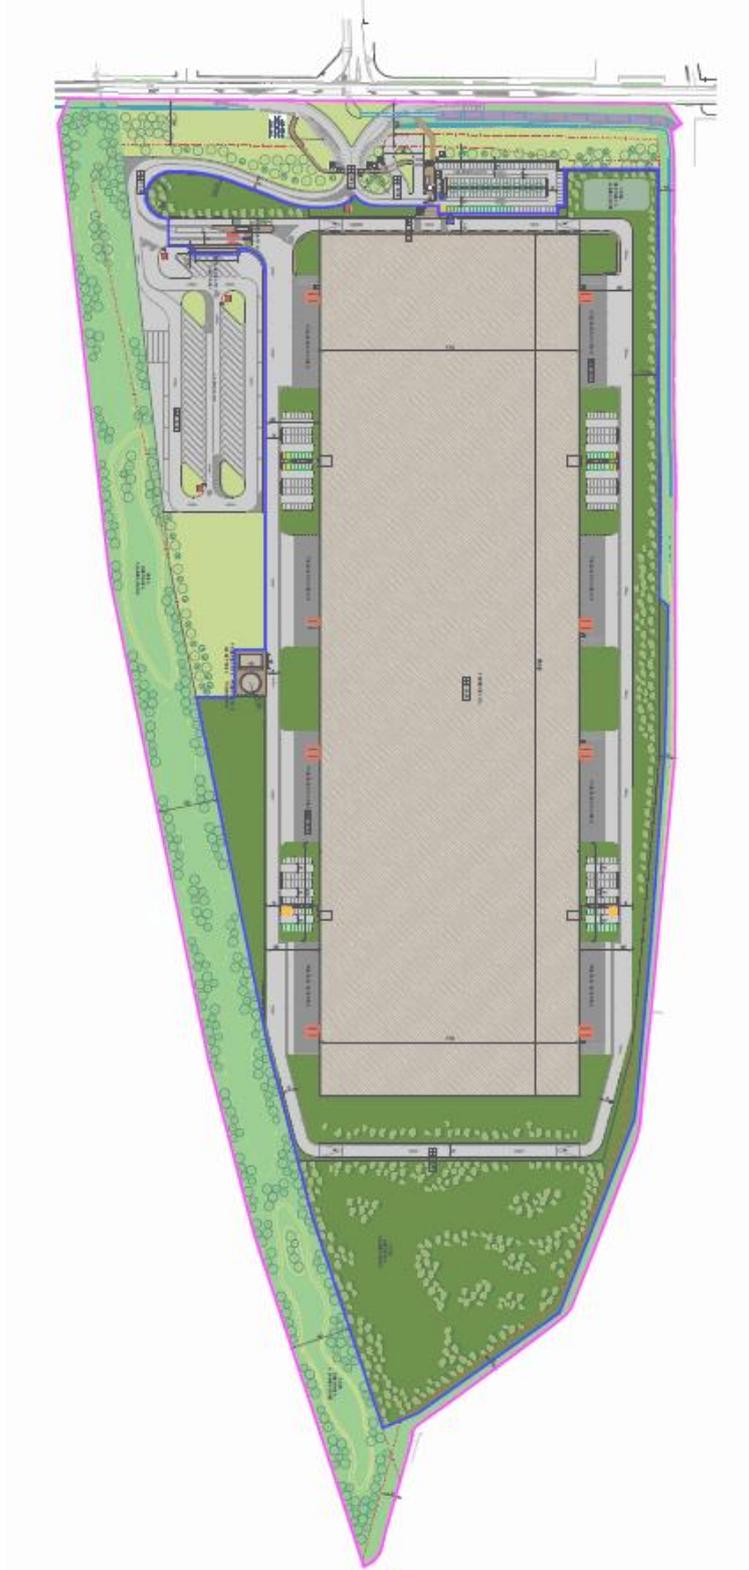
Estratto della planimetria generale – tipologico del possibile insediamento
